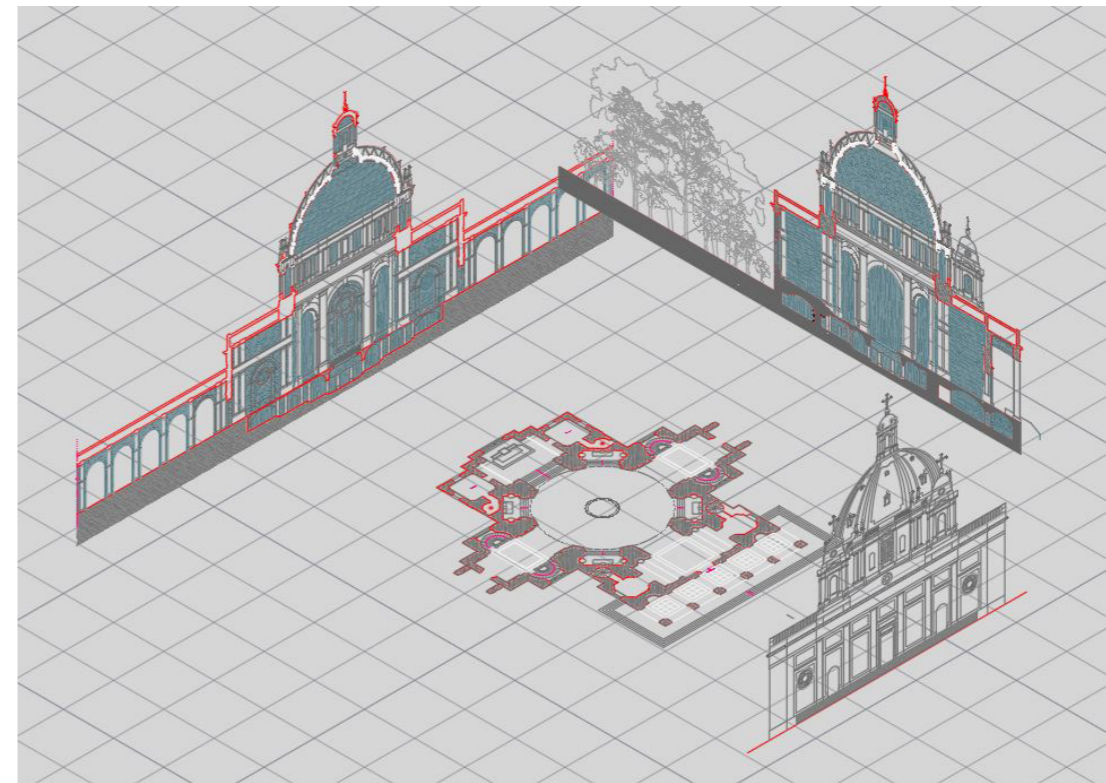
Captura del proceso de disposición de planimetría para su levantamiento. Elaboración propia.
